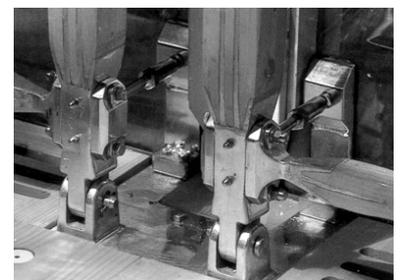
IBM Travelling Pavilion, Konstruktionsdetail. Architekt: Renzo Piano. *Quelle: Buchanan, 1994.
